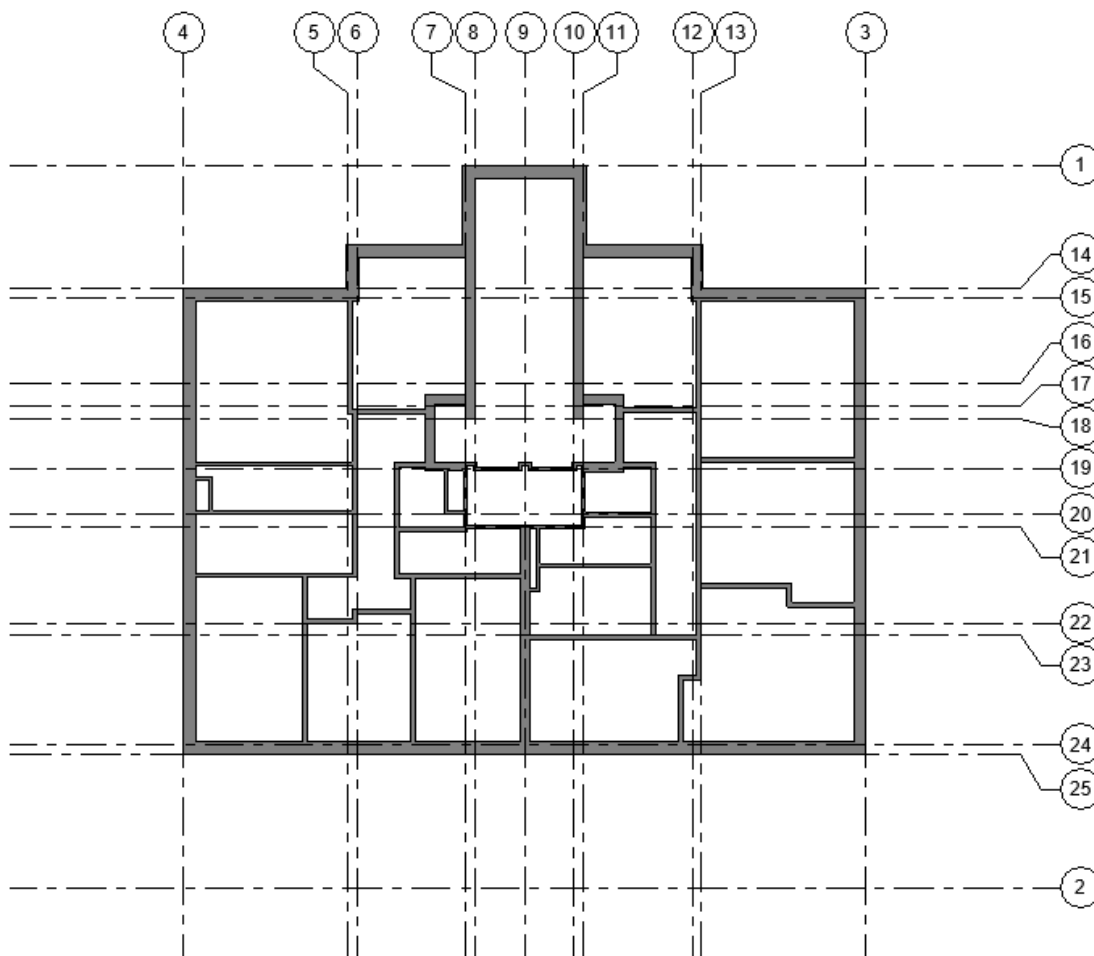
Planta com as paredes exteriores e interiores do modelo de arquitetura BIM do Piso Tipo.
